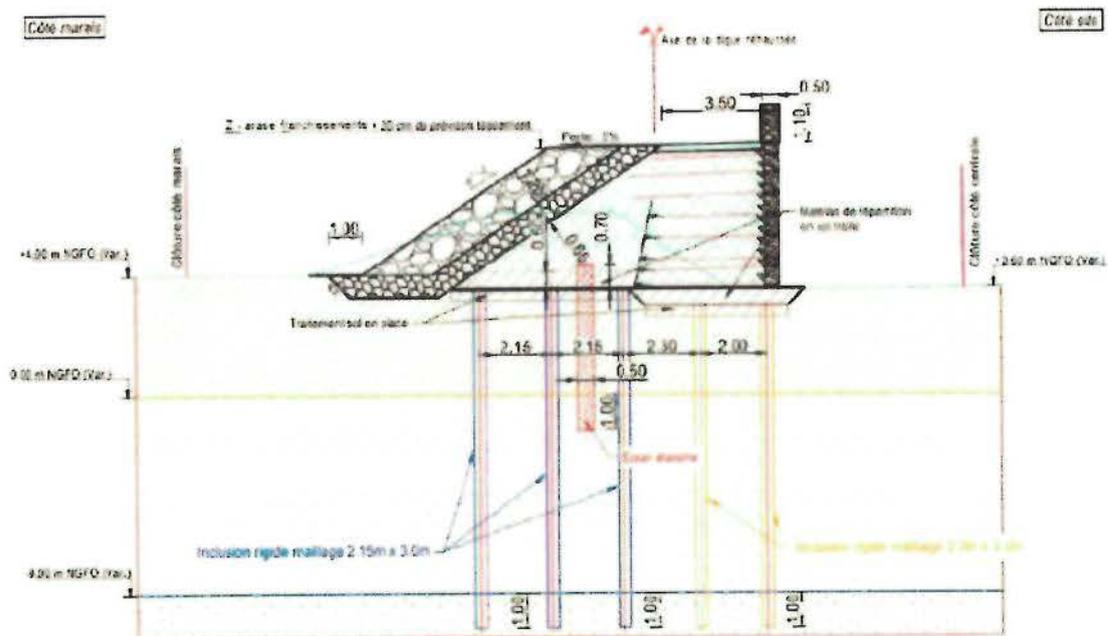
Renforcement de la fondation des digues avec mur vertical par inclusions rigides.
